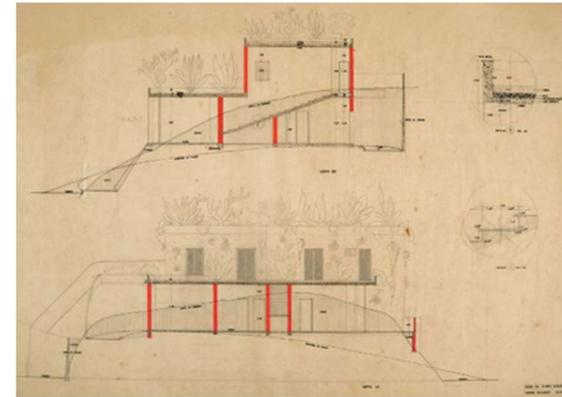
Planimetría: sección Casa do Chame Chame.
